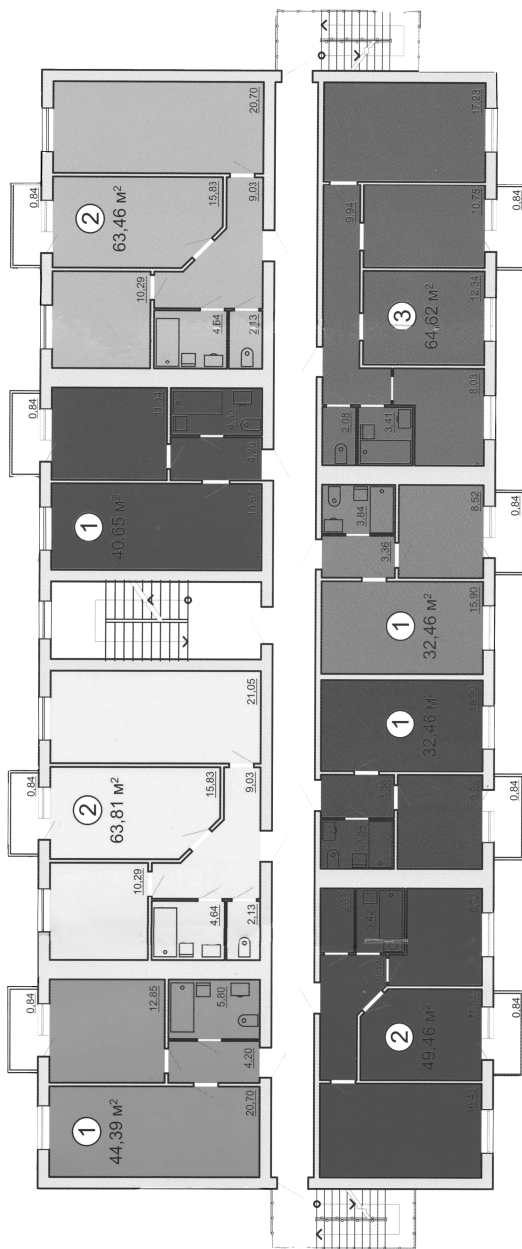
План типового поверху житлового будинку по вул. Щаслива, 1
